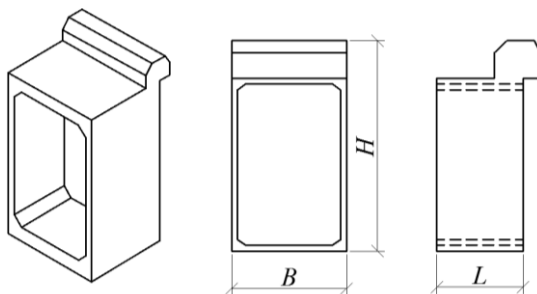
Звенья оголовка для трубы водопропускной железобетонной прямоугольной сборной
